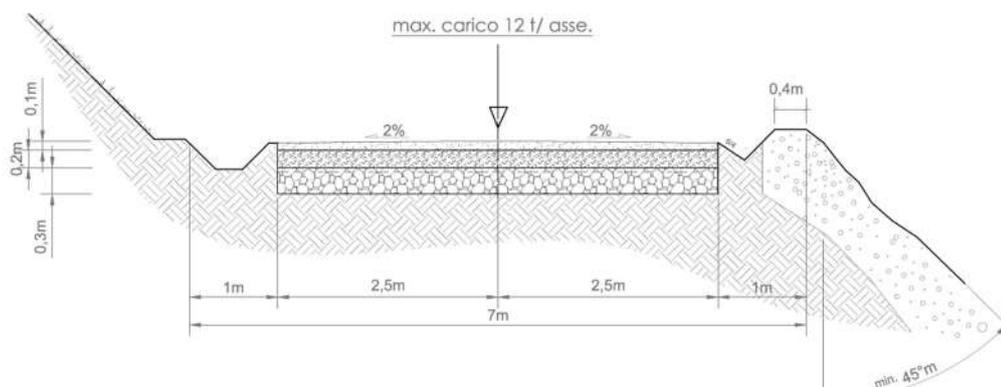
Sezione stradale tipo con scarpata (mezza costa)
